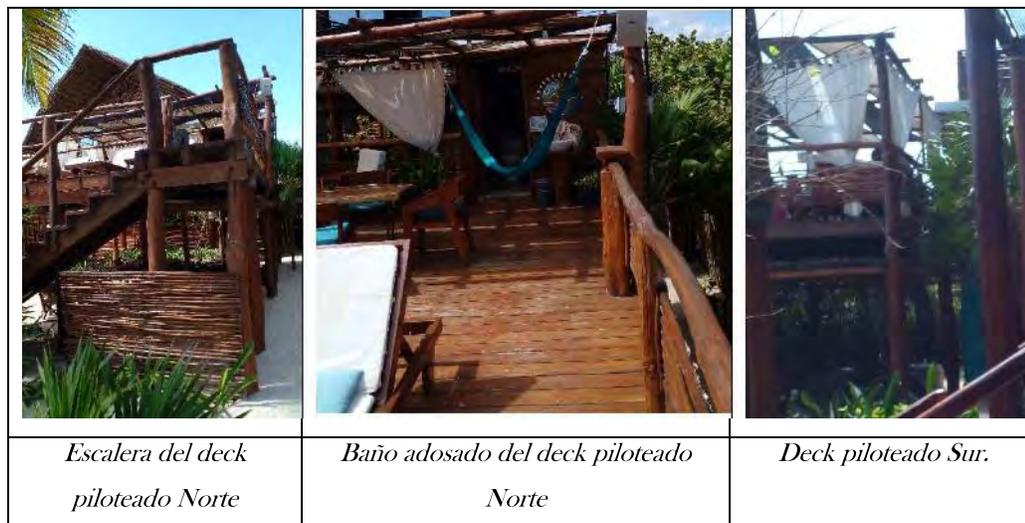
Condiciones actuales del deck de madera piloteado.
